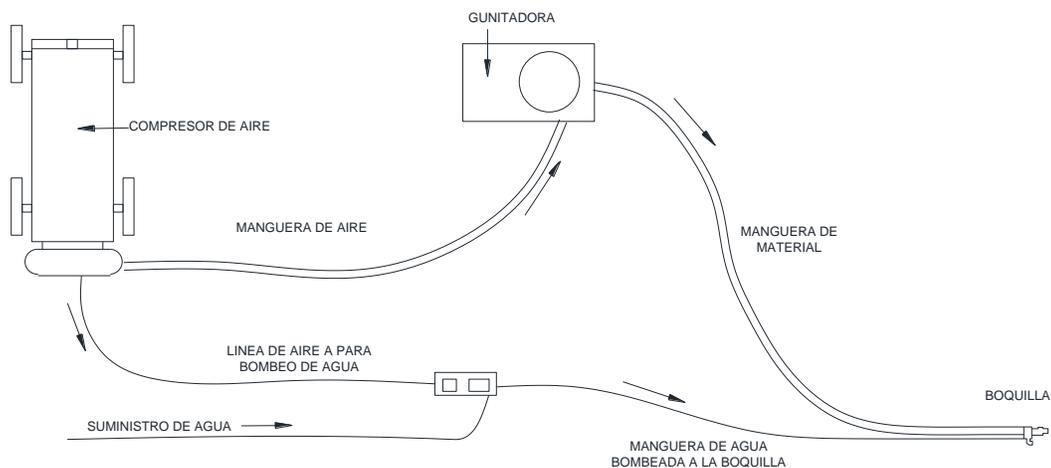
Diagrama para lanzamiento de concreto refractario. Fuente: Allentown Instruction Manual.
